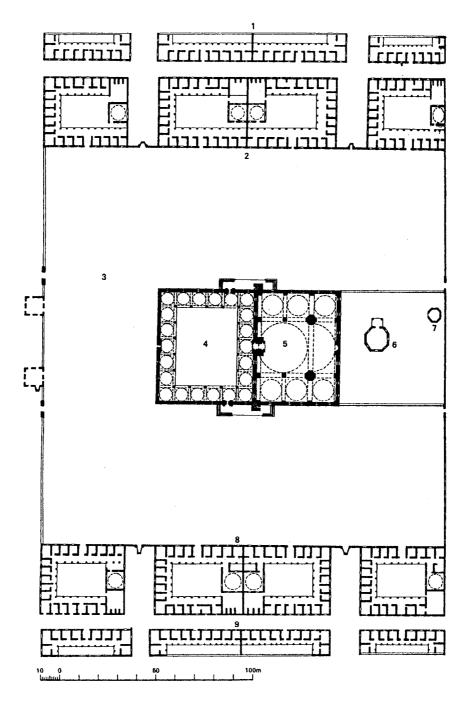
مسقط أفقي لجامع اوج شرفلي في ادرنه (عن: Goodwin).
